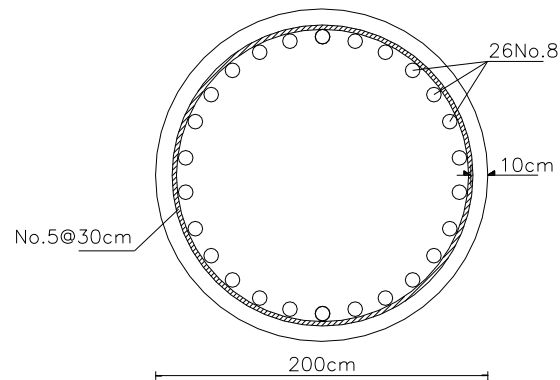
Sección transversal de la columna a reforzar (vista transversal).
